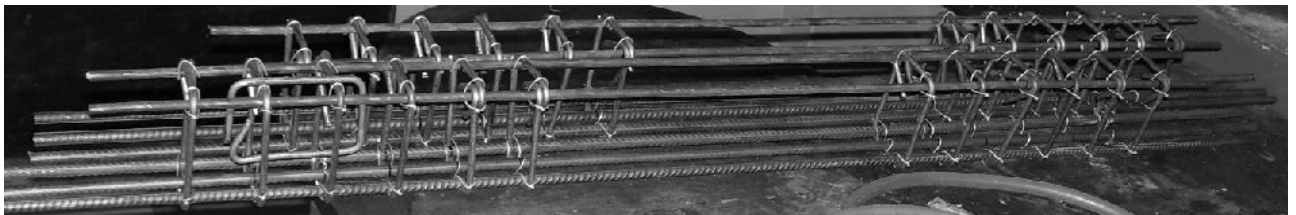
Ferrailage des poutres de contrôle (non corrodées)
